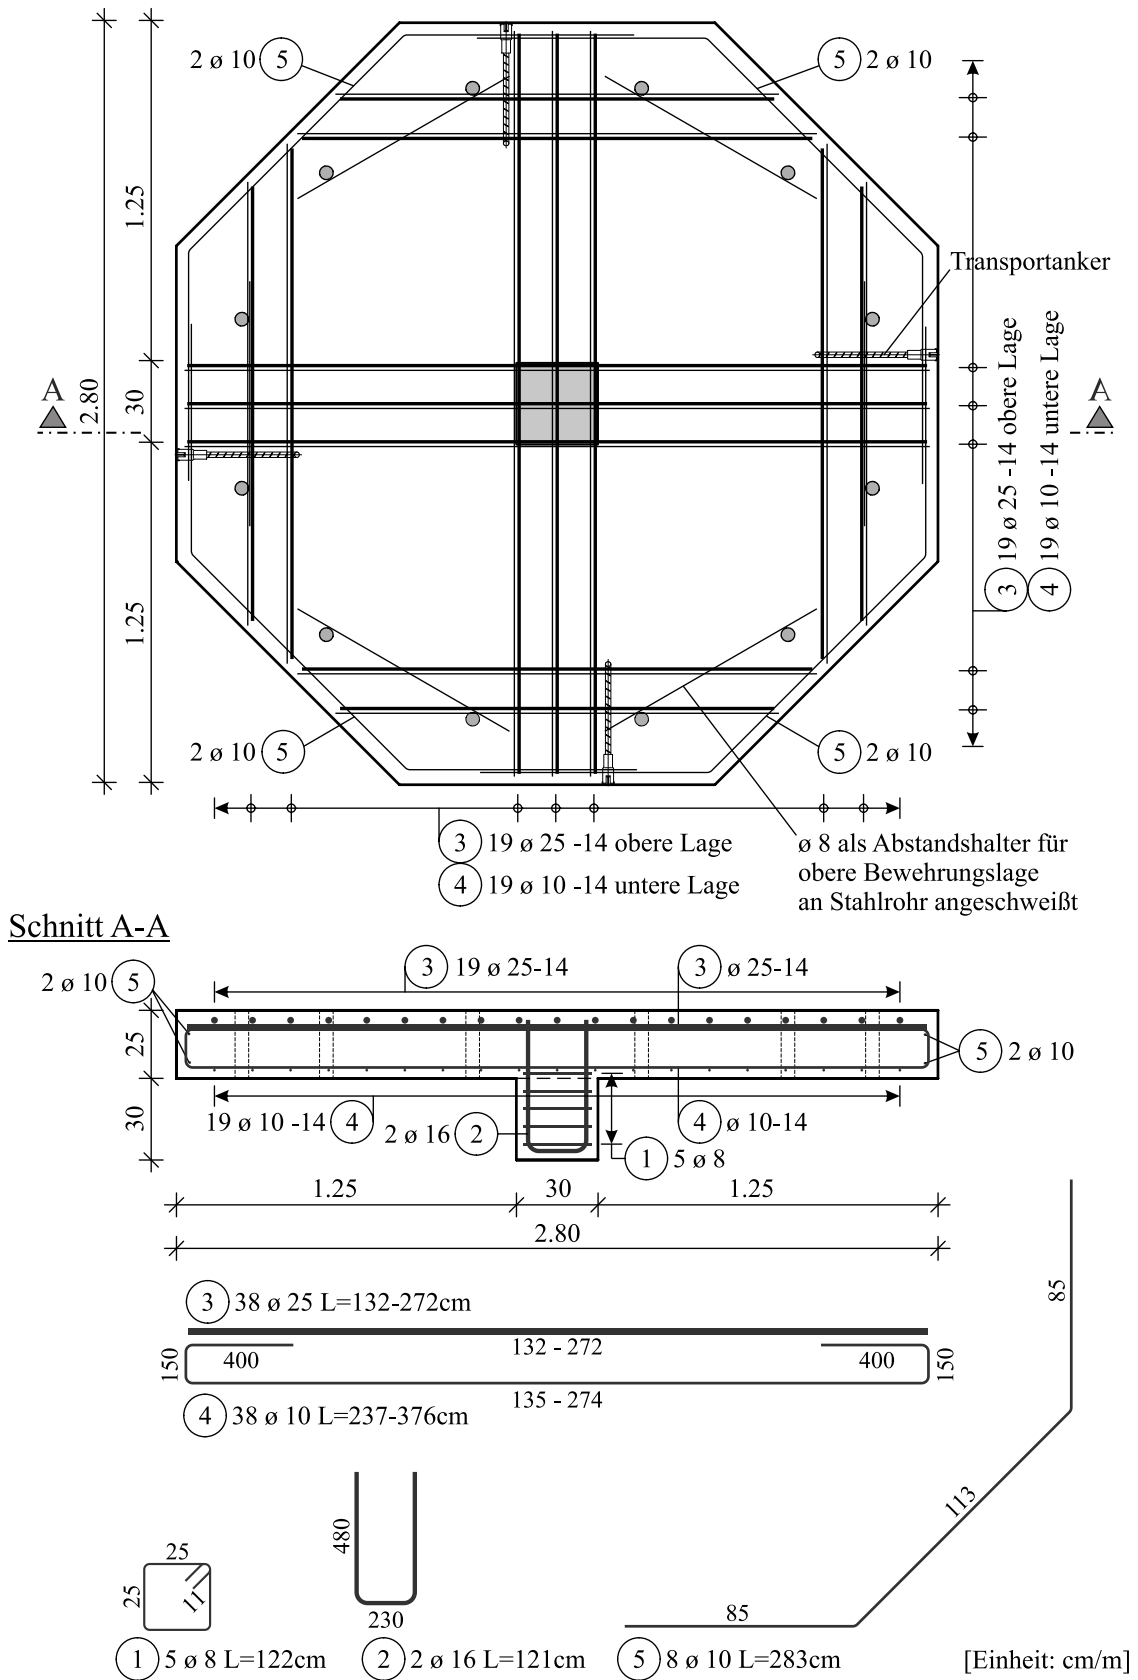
Bewehrungsplan des Versuchskörpers M3-25-1.75
